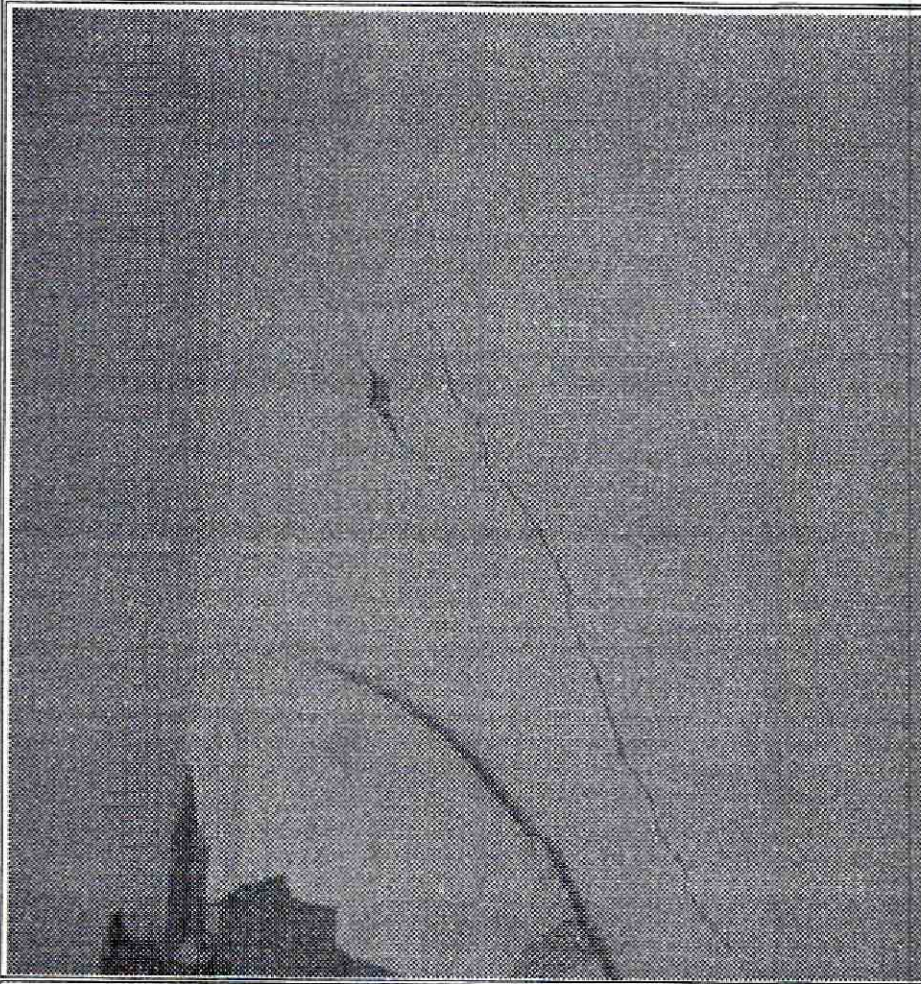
Grieta tendencia diagonal habitación segundo nivel de la vivienda
